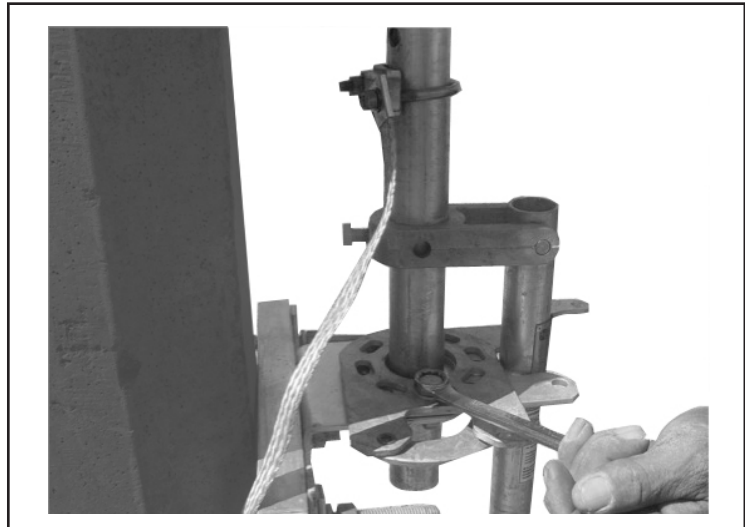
Apriete de tornillos para asegurar las placas de tope a la placa de apoyo.
